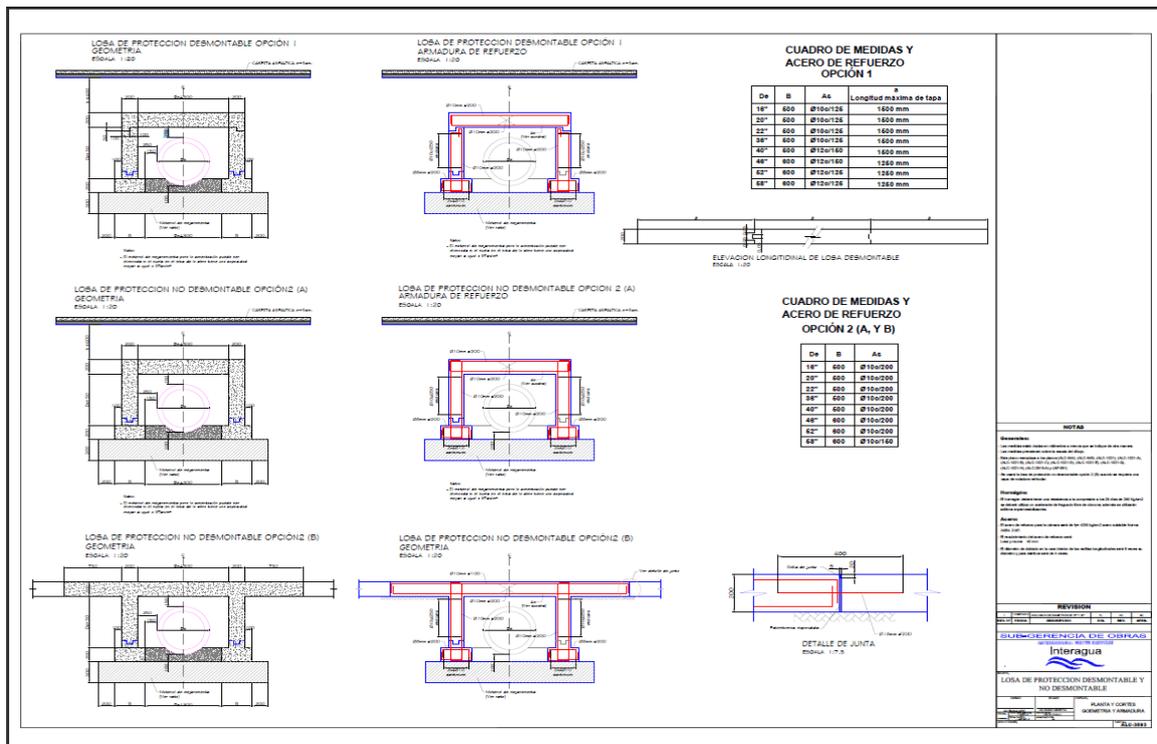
Diseño de losa de protección. Fuente (Interagua).
